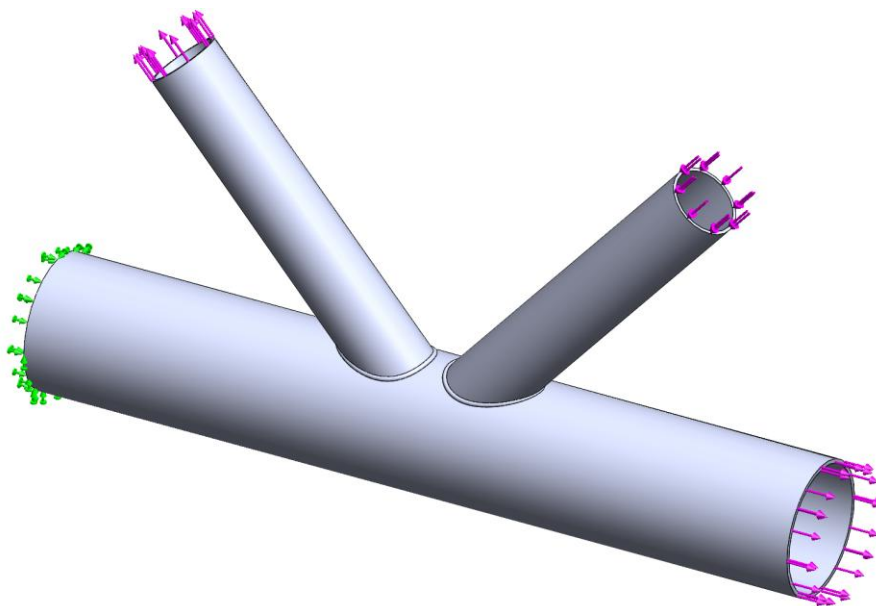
Умови закріплення та навантаження зварного вузла нижнього пояса ферми
